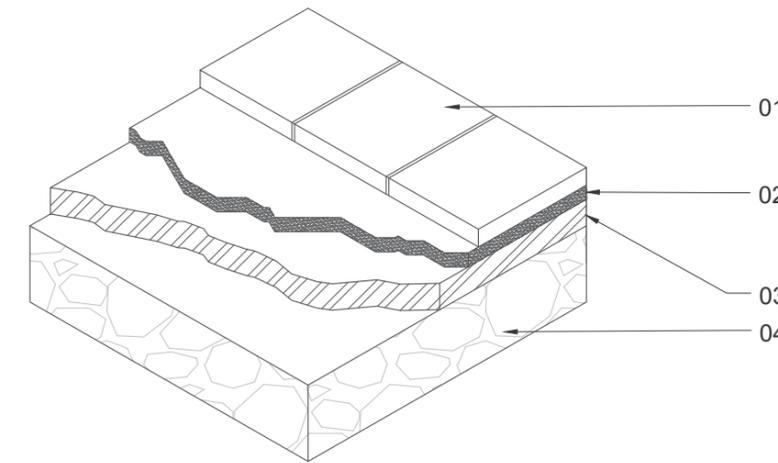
ISOMETRÍA DE DETALLE DE PISO DE ADOQUÍN
